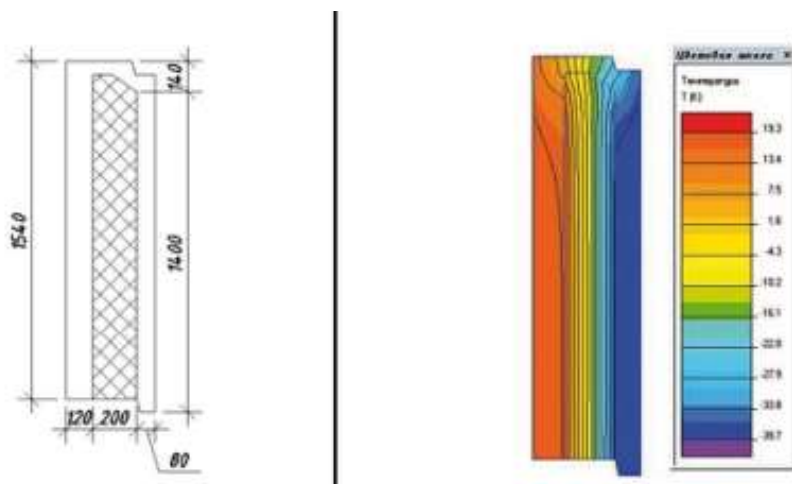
Теплотехнічний аналіз перерізу зовнішньої панелі з керамзитобетону.
